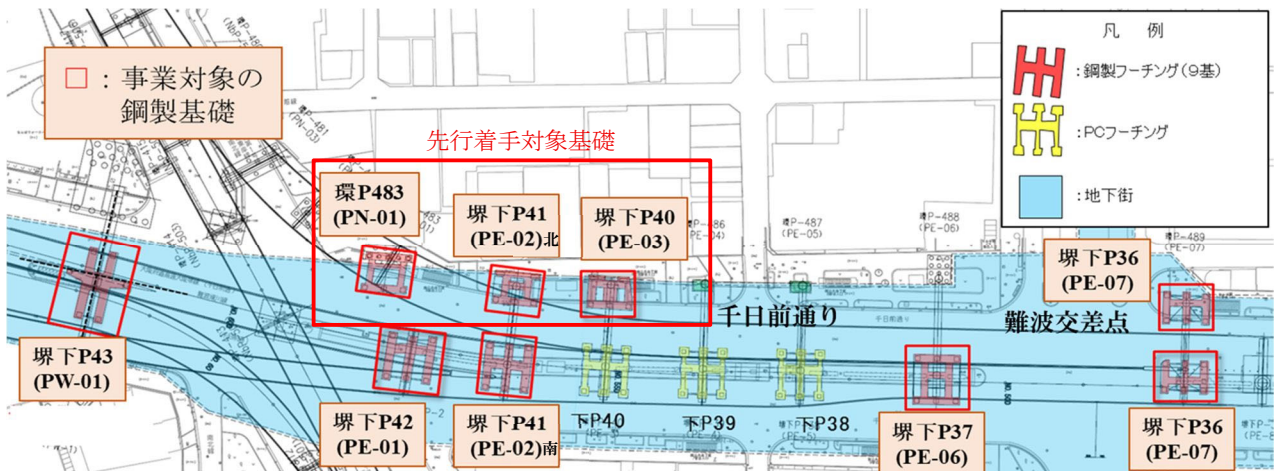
湊町・難波地区鋼製基礎大規模更新工事 橋脚基礎配置図
